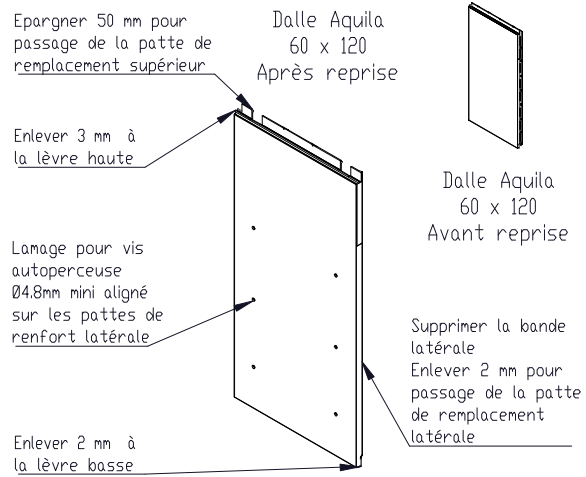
Aquila Bardage 60x120 – Vue de Face – Remplacement de dalle (5 fixations par plaque)
